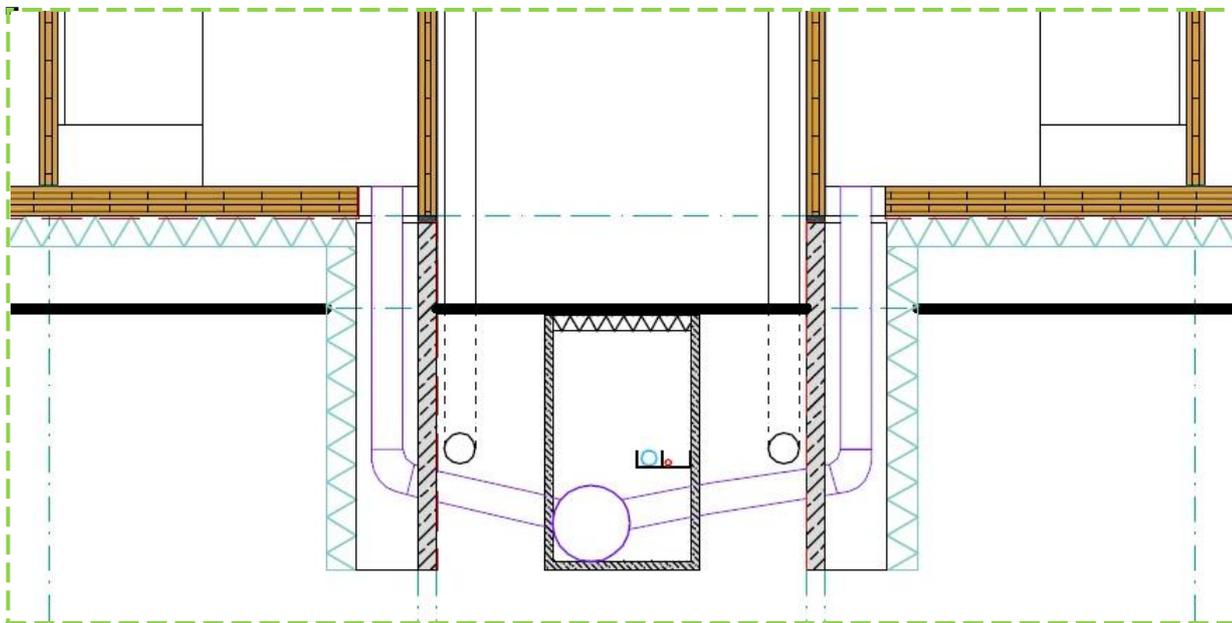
Ausschnitt des Erdgeschossgrundrisses: Sanitär- und Küchenbereich
